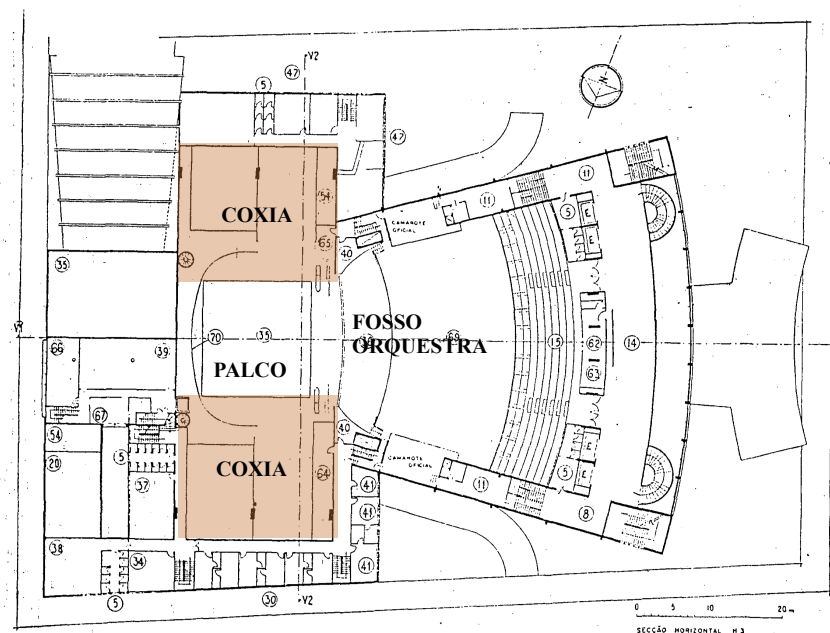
Planta baixa do projeto arquitetônico do Teatro Guaira
